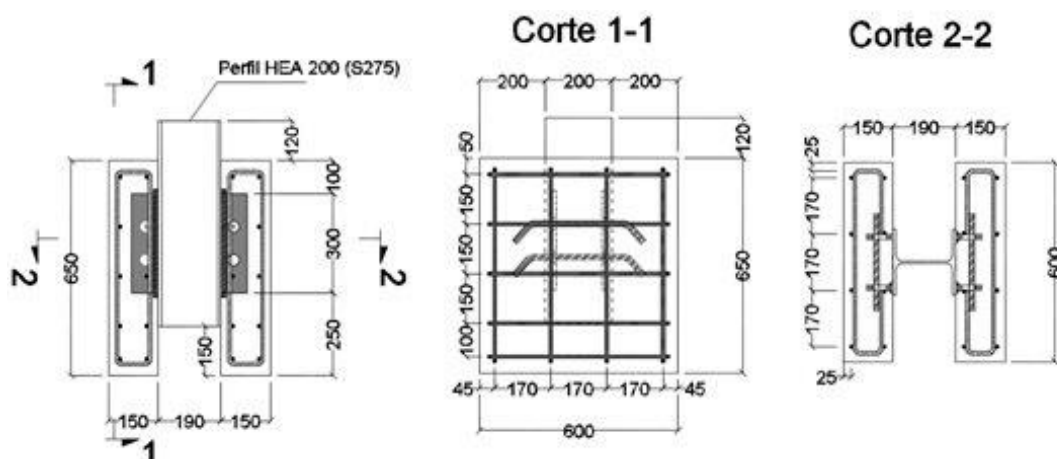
Geometria do provete de ensaio do conector 2P-2F-140E-AR16 (dimensões em mm)
